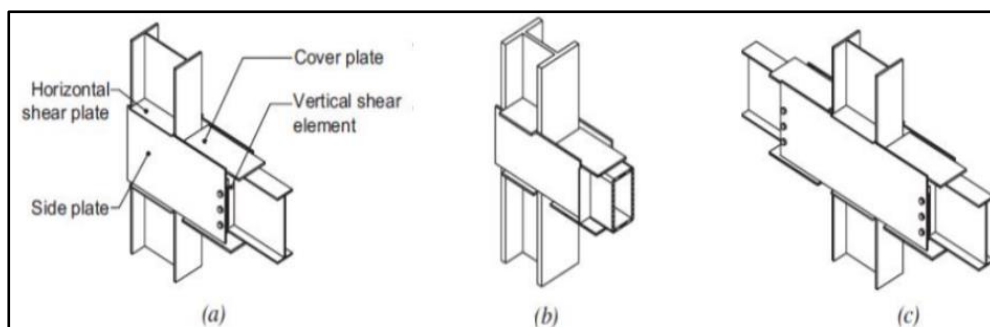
Modelos de conexión SIDE-PLATE; a) Conexión de viga y columna de ala ancha a una cara, (b) Viga HSS con placas de cubierta hacia columna de alas anchas, (c) construcción de viga y columna con ala ancha de dos lados. AISC358 (2016)
